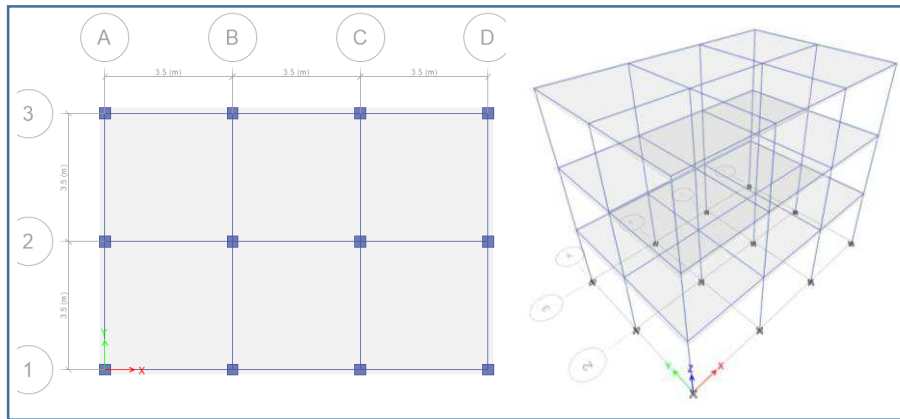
, Estructura de 3 pisos con viga banda diseñada en ETABS
